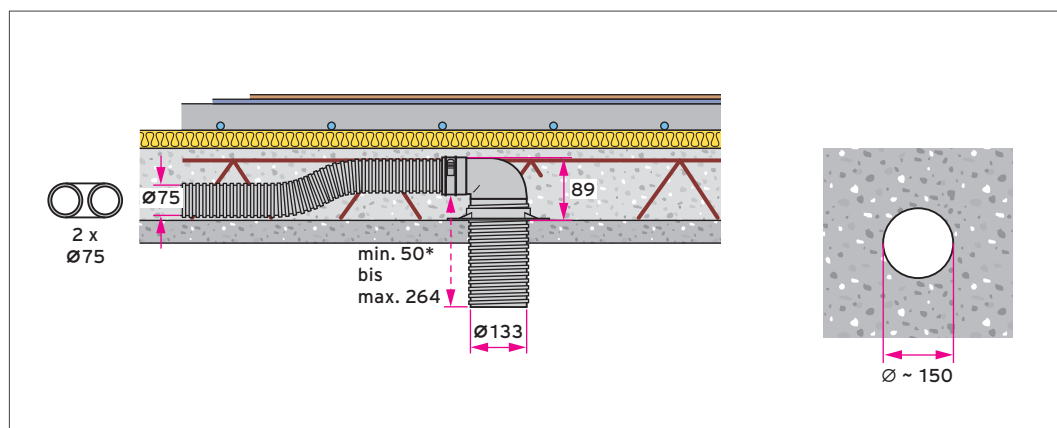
Luftein-/auslass Verlegung in der Rohbetondecke
